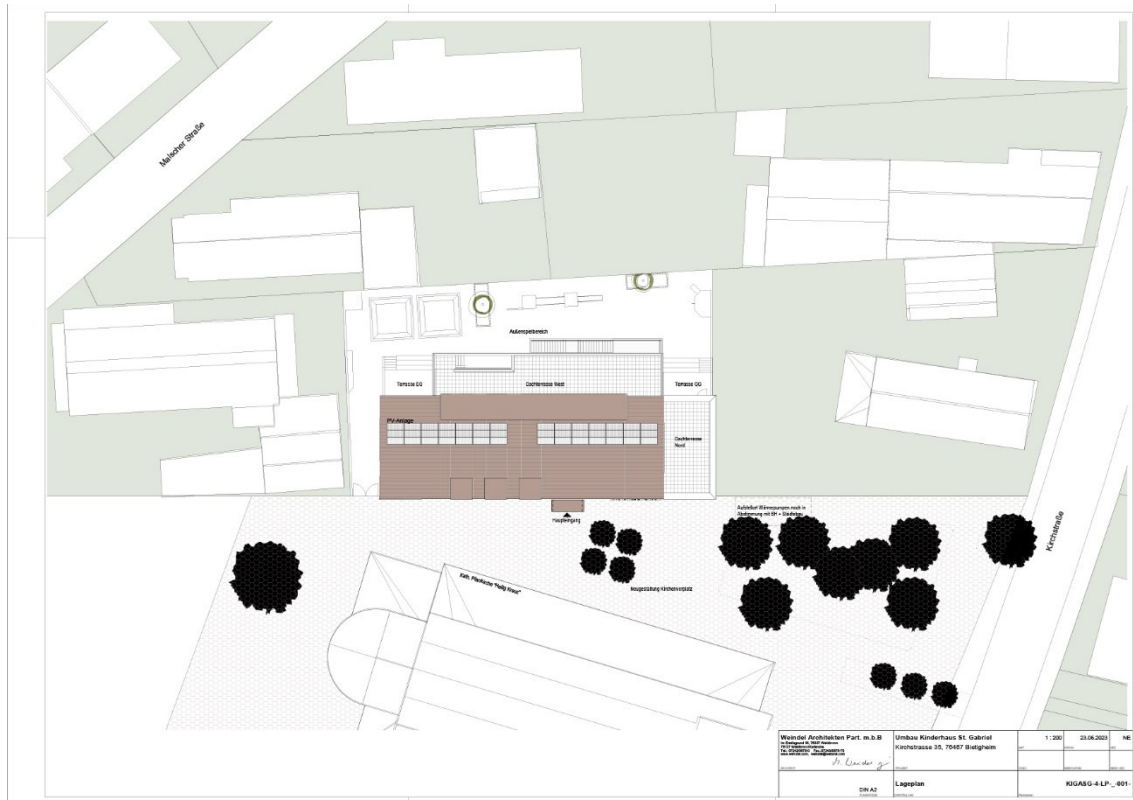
Lageplan Umbau Kinderhaus St. Gabriel, o.M. Quelle: Büro Weindel Architekten, Waldbronn (C) 23.06.2023
